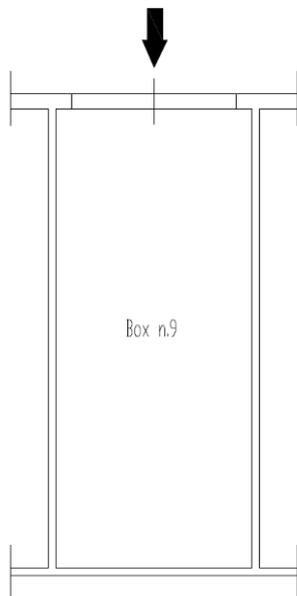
Planimetria del garage n.9 oggetto di pignoramento
